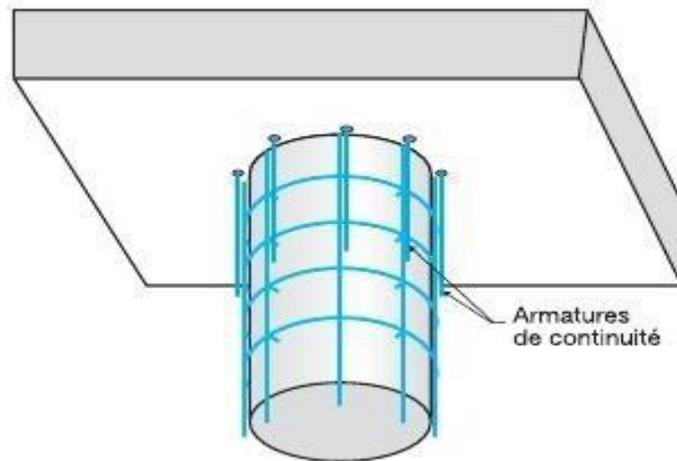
Chemisage en béton armé des poteaux (ferrailage complet)
